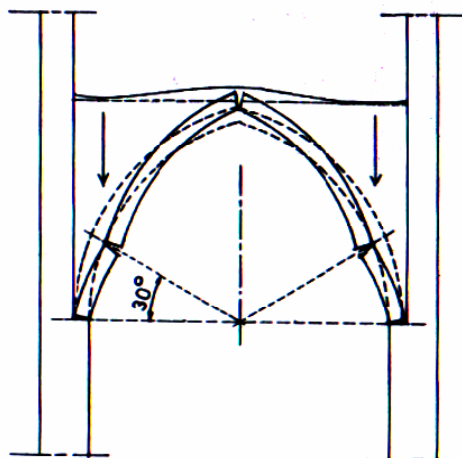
Fissuração tipo devido a cargas verticais em arcos e abóbadas ogivais.
